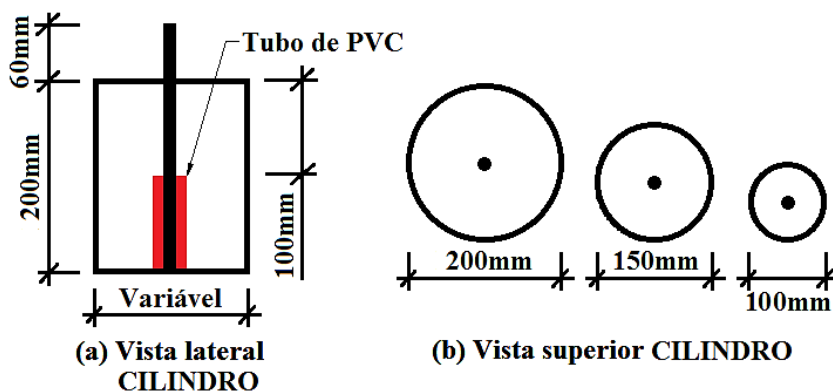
Dimensões dos corpos de prova da Etapa II.
